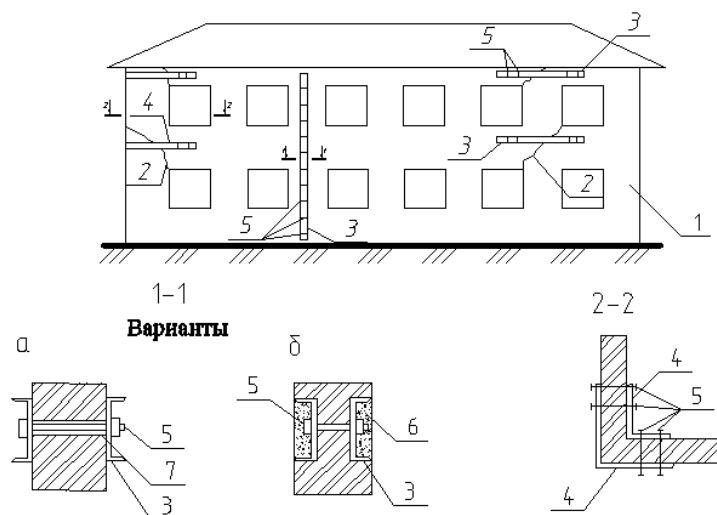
Усиление стен установкой металлических накладок: 1 – деформируемое здание; 2 – трещины в стенах; 3 – накладки из швеллеров; 4 – накладки из металлических пластин; 5 – стяжные болты; 6 – штраба для установки накладок, заделываемая раствором; 7 – отверстия в стенах для болтов (после установки зачеканить раствором)
